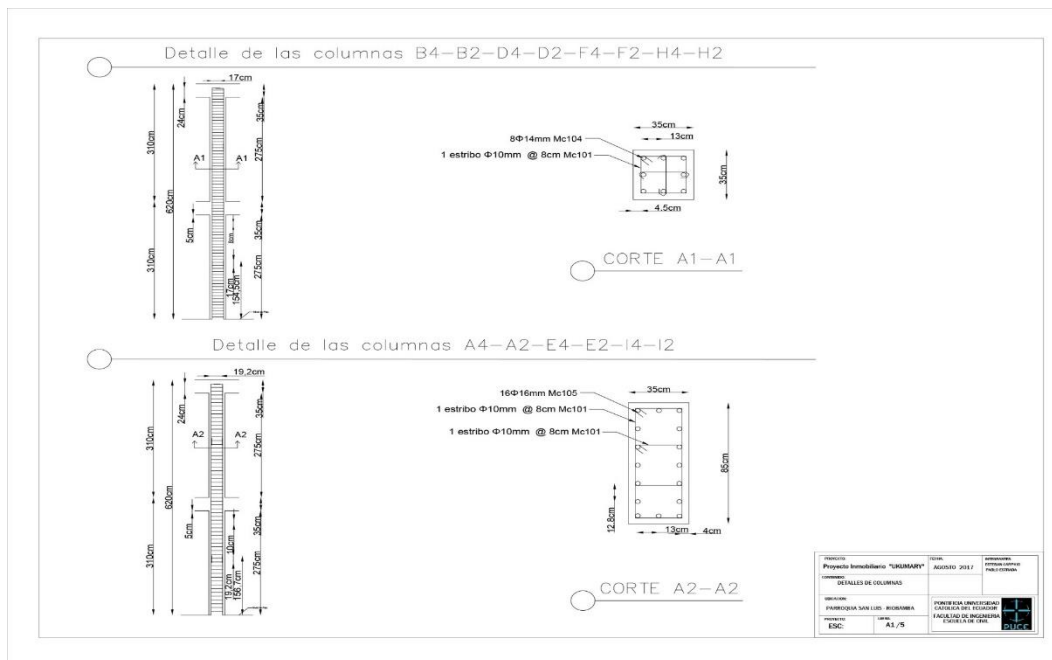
Detalle de planos estructurales - columnas – Fuente: Carphio (2017)
